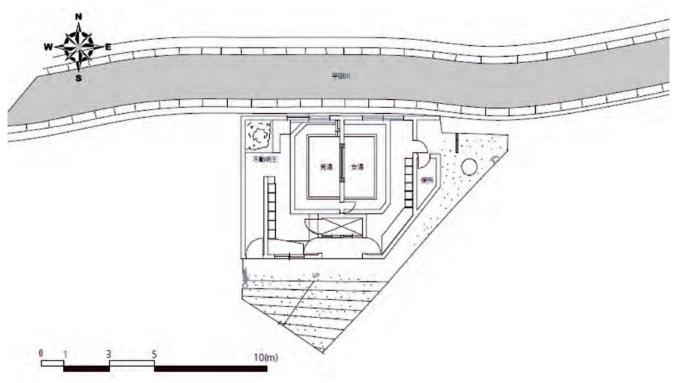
鉄輪温泉地区 谷の湯B1F平面図
